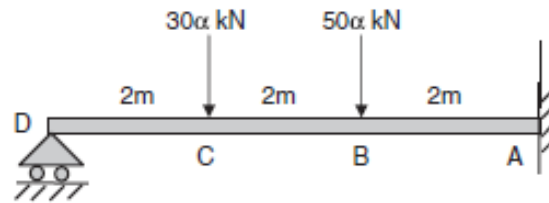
Viga engastada e apoiada (WONG, 2009)
